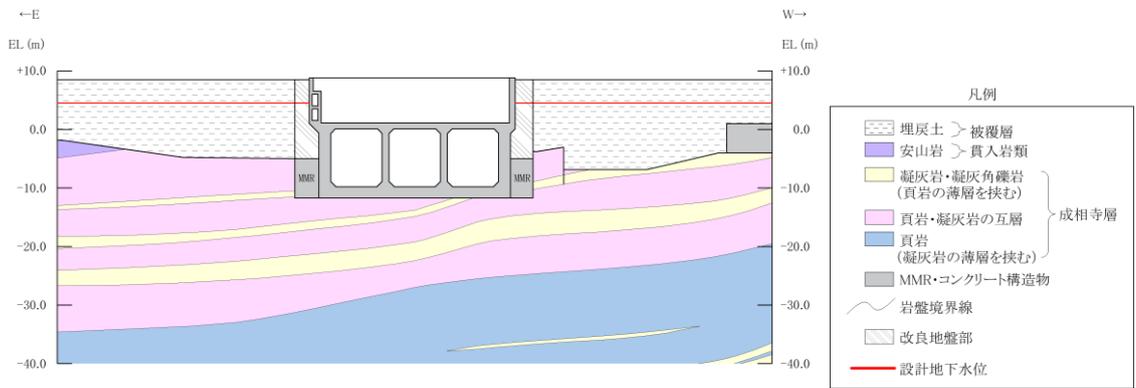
(2) 取水槽 地質断面図 (B-B 断面)
